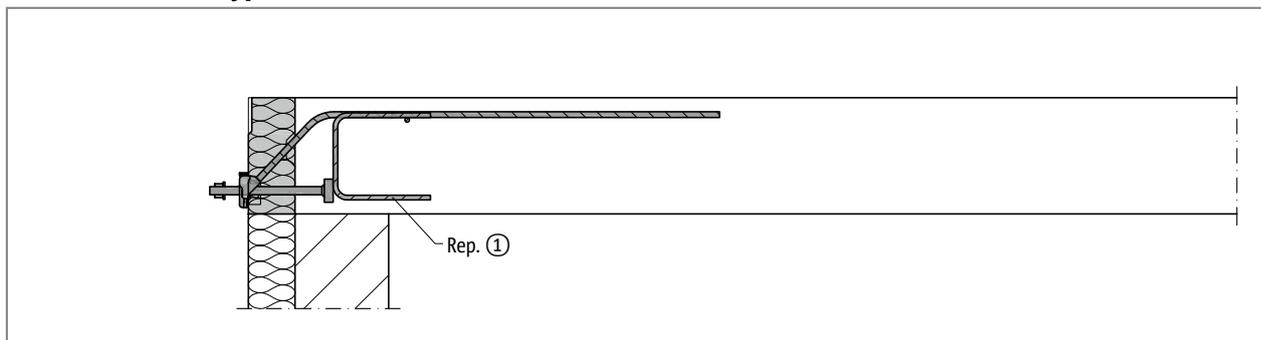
Schöck Isokorb® T type SQ : renforcement sur site, coupe
